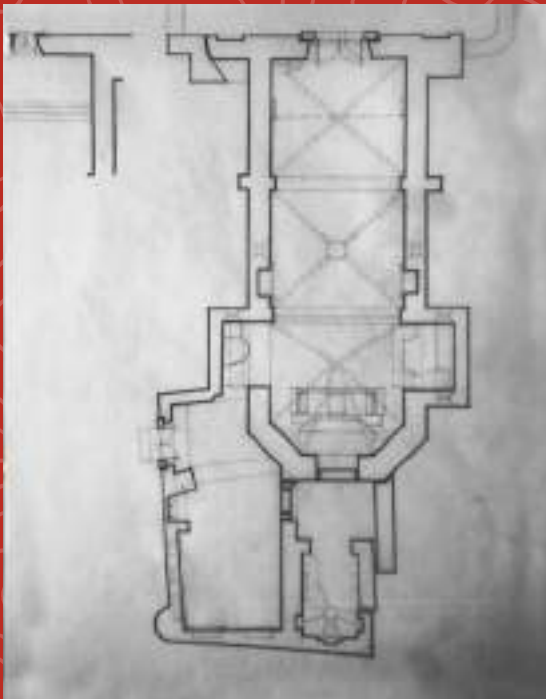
Planta arquitectónica de la capilla de San Miguel Viejo. Autora: Olga Adriana Hernández. 1992.
